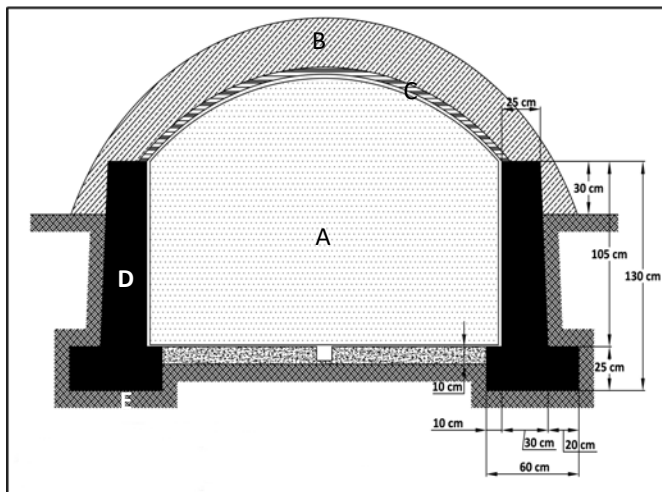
Coupe d'un silo – couloir rempli, de 1 mètre de hauteur (A : ensilage ; B : remblai de terre ; C : bâche en plastique ; D : parois en béton ; E : sol).
